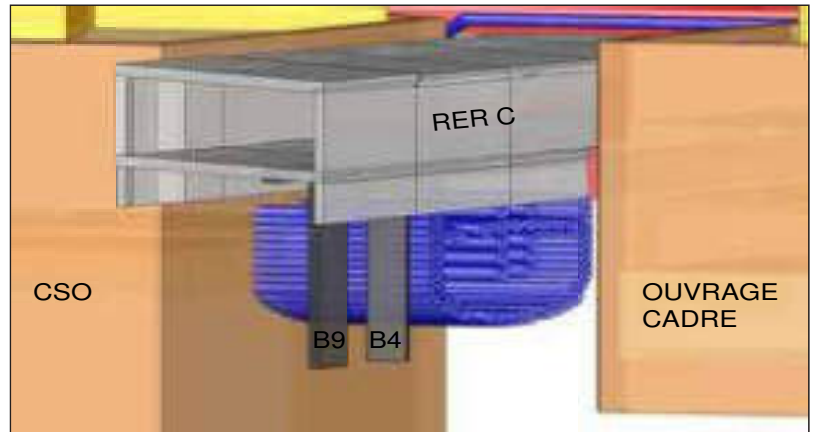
Vue 3D de la coque congelée - 3D view of the frozen shell
